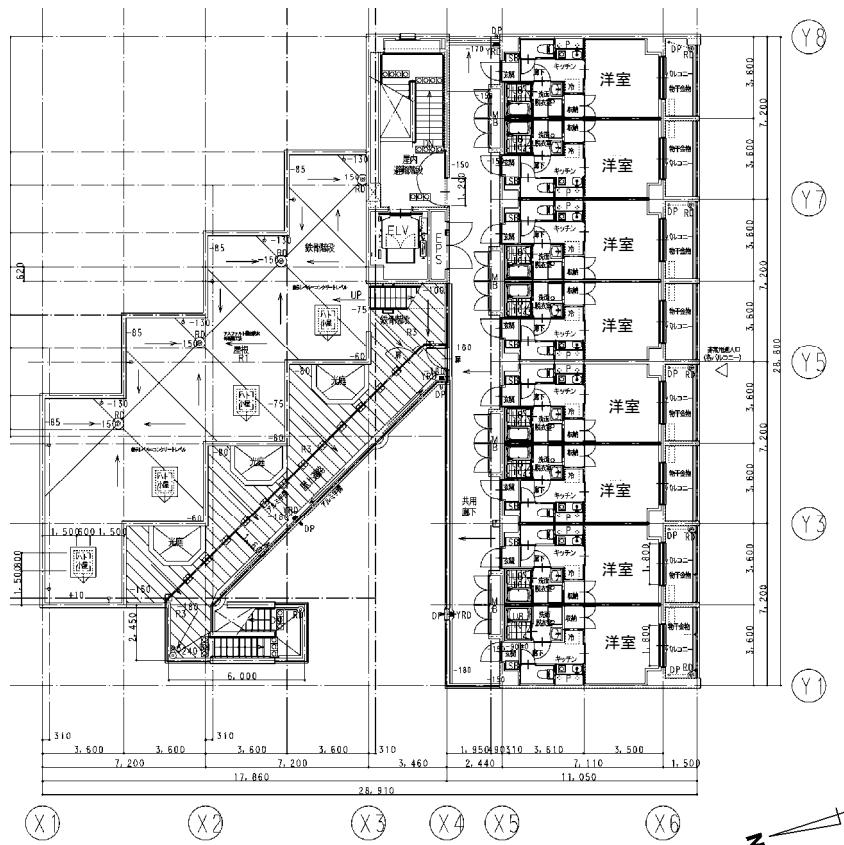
研修医宿舎棟建築平面図 (6階)
